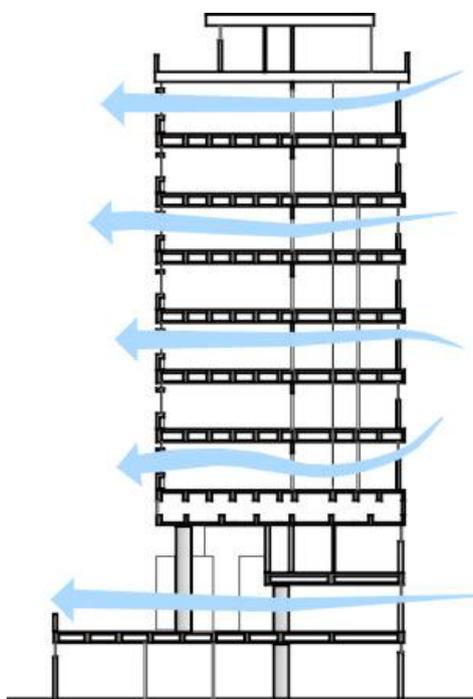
Esquema em corte da ventilação cruzada nas internações
